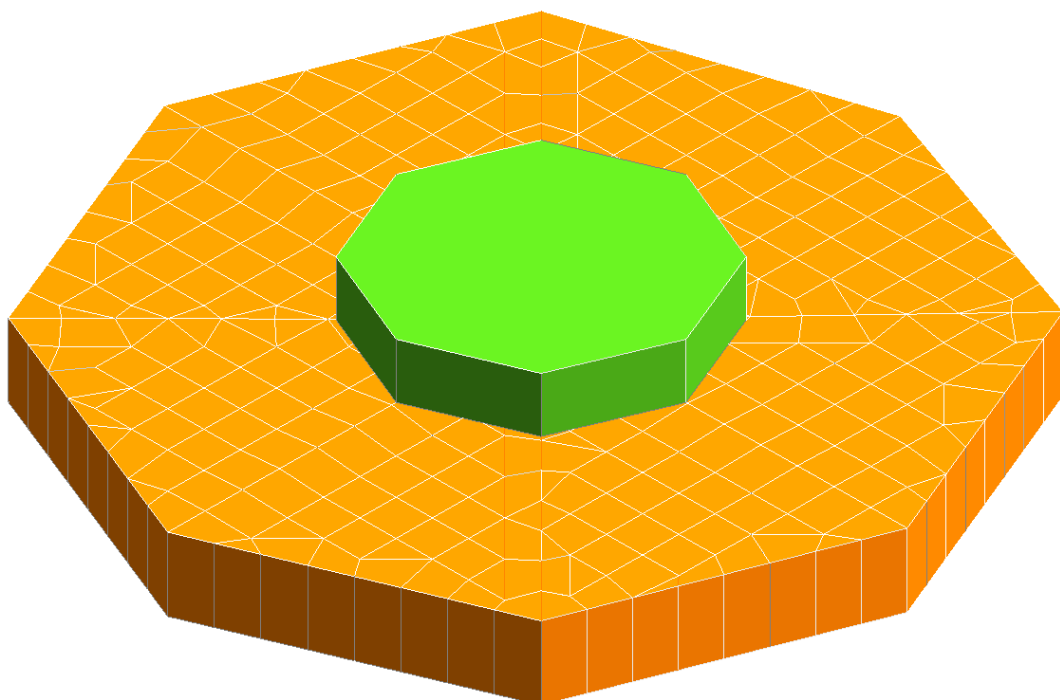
Discretizzazione mediante elementi shell della fondazione.
